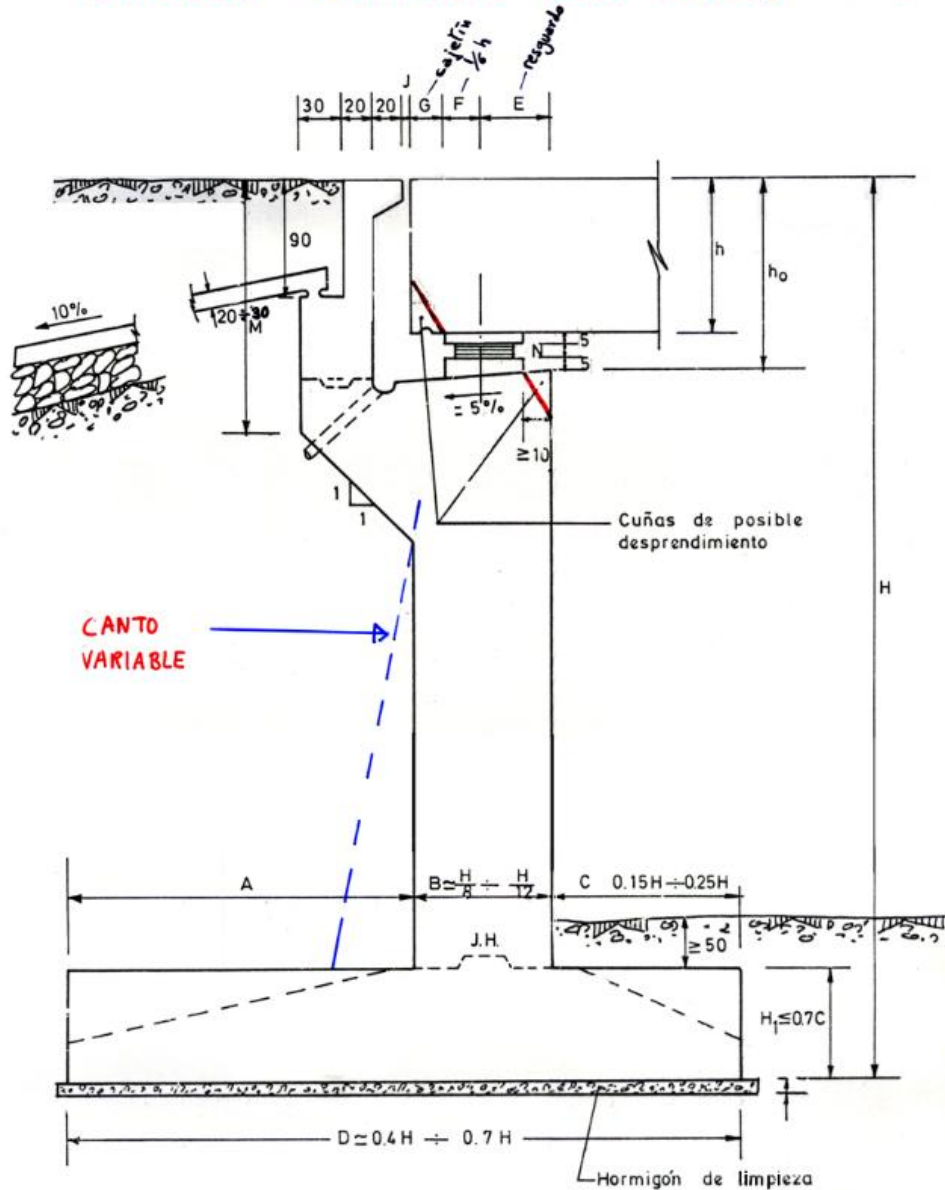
FIGURA .- Sección transversal típica de un estribo con muro frontal de alzado macizo
